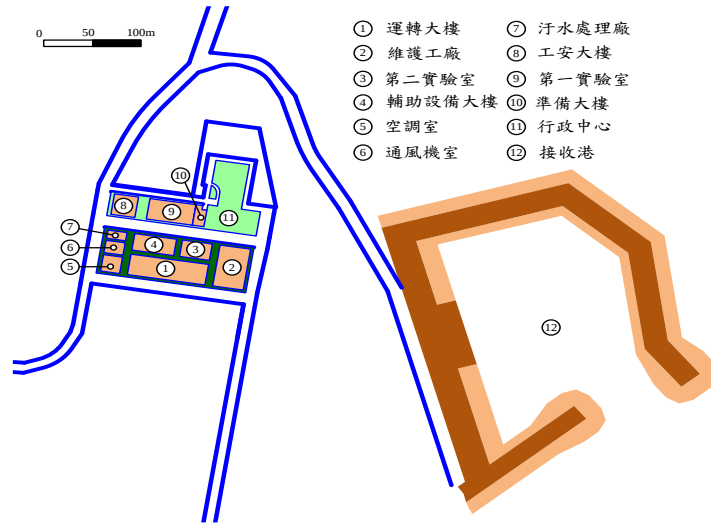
達仁鄉建議候選場址輔助區平面布置圖
